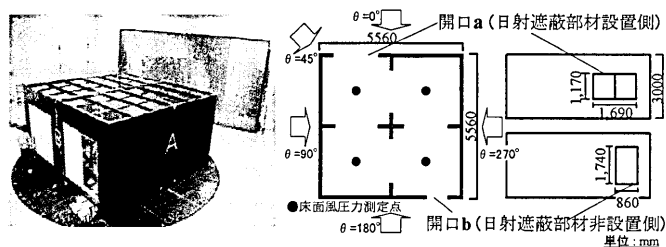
実大風洞及び模型 図1 建物模型の平面図・立面図 (床面風圧力測定点および開口部位置、風向の定義)
